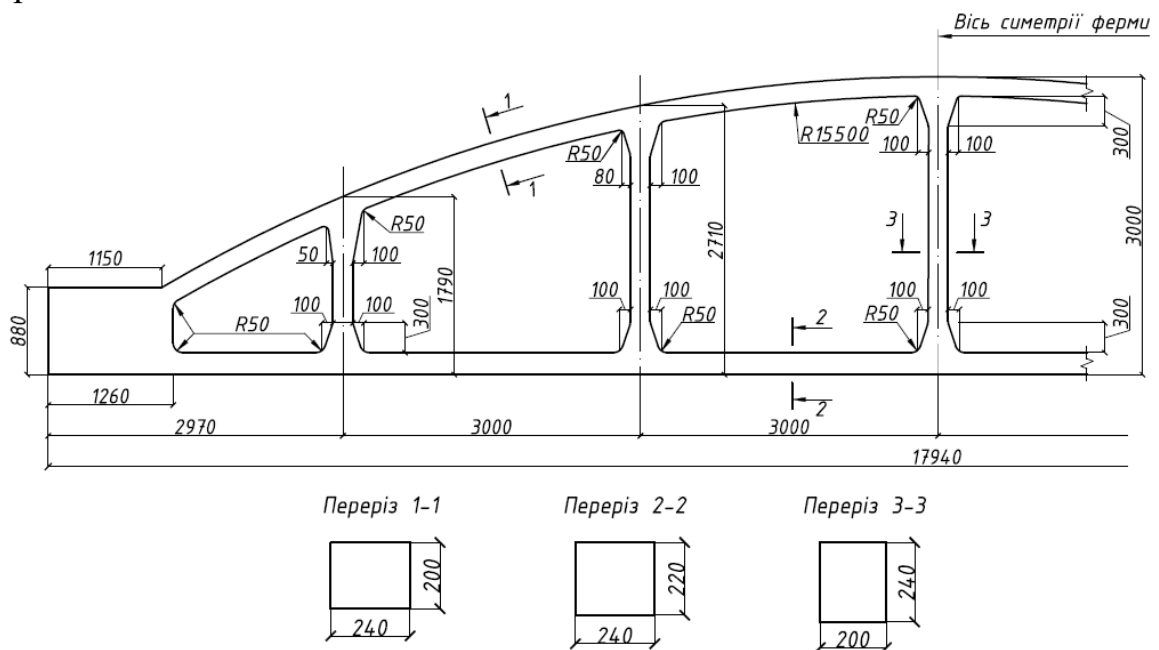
Опалубне креслення залізобетонної ферми ФБС 18
